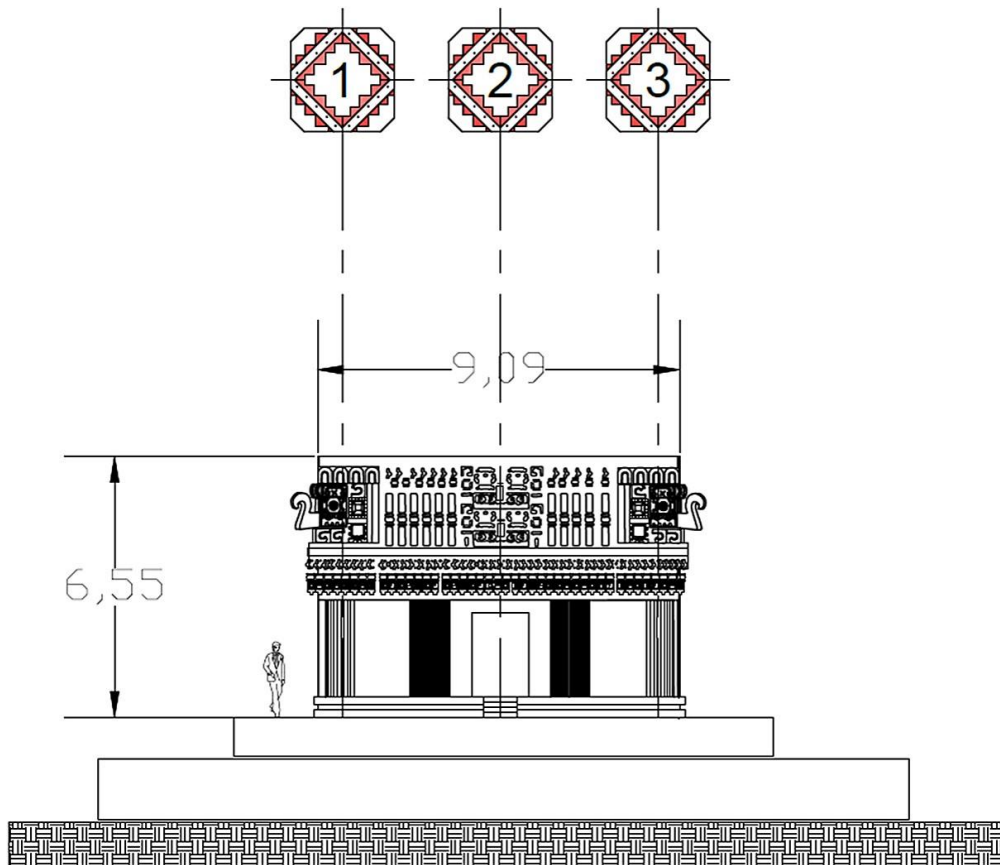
Cortés Juan. Fachada Poniente del Edificio uno del Adivino. 2016. Planos arquitectónicos. Basado en Andrews 1975 y Le Plongeon 1873- 1881. Acervo J. Cortés.
